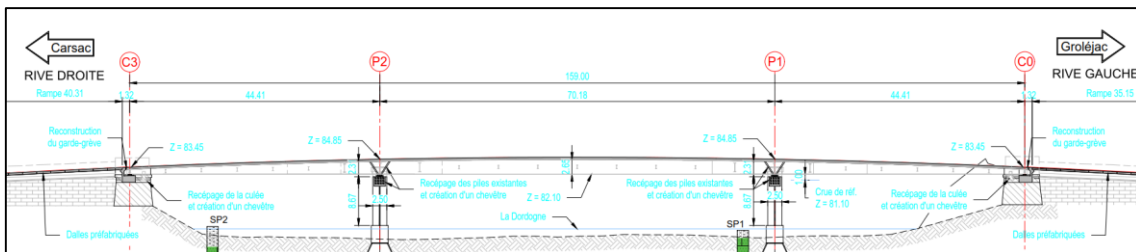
Coupe longitudinale de l'ouvrage définitif (Source : Arcadis)
